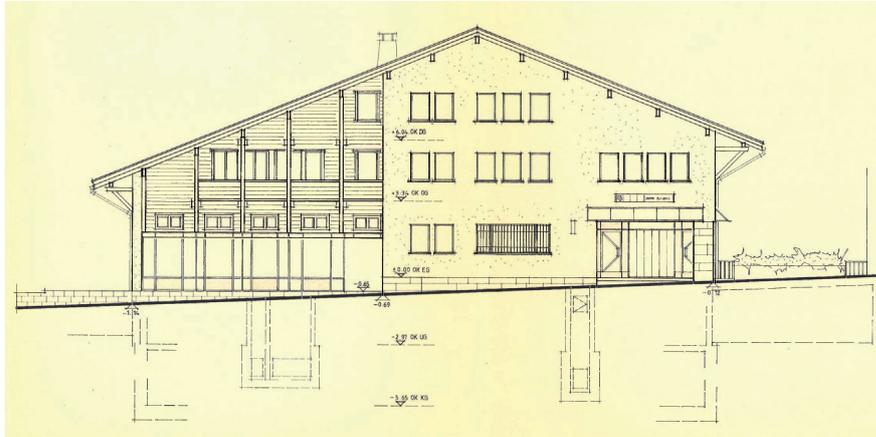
Ansicht Fassade Nord, Ausführungsplan von 1993
